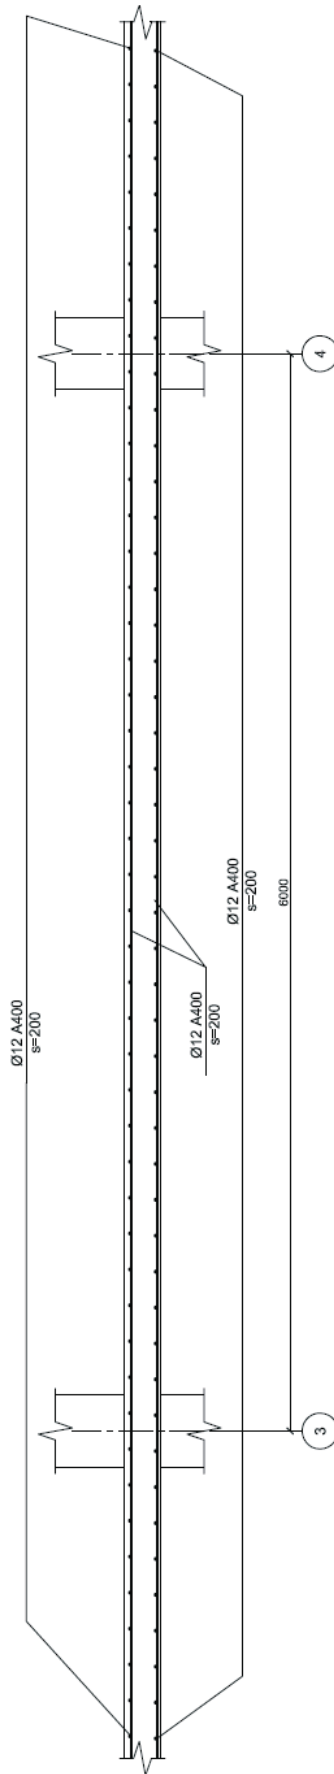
Армирование плиты перекрытия в осях 3-4.
